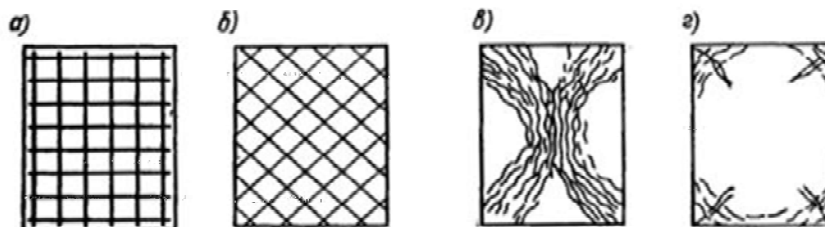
Схемы армирования и характер разрушения при испытании плит, опертых по контуру
